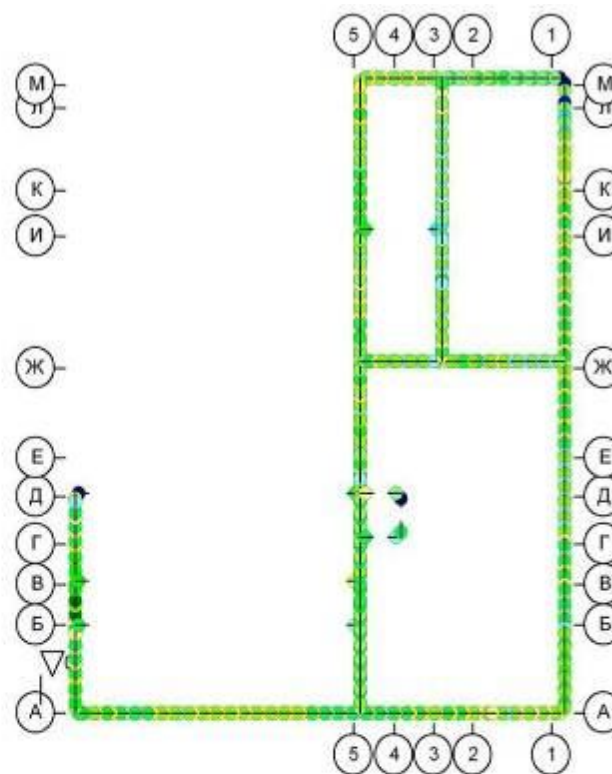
Нагрузка от внутренних стен на ленточные фундаменты здания в осях «5-1/А-М» от комбинации загрузжений С5, тхм².
